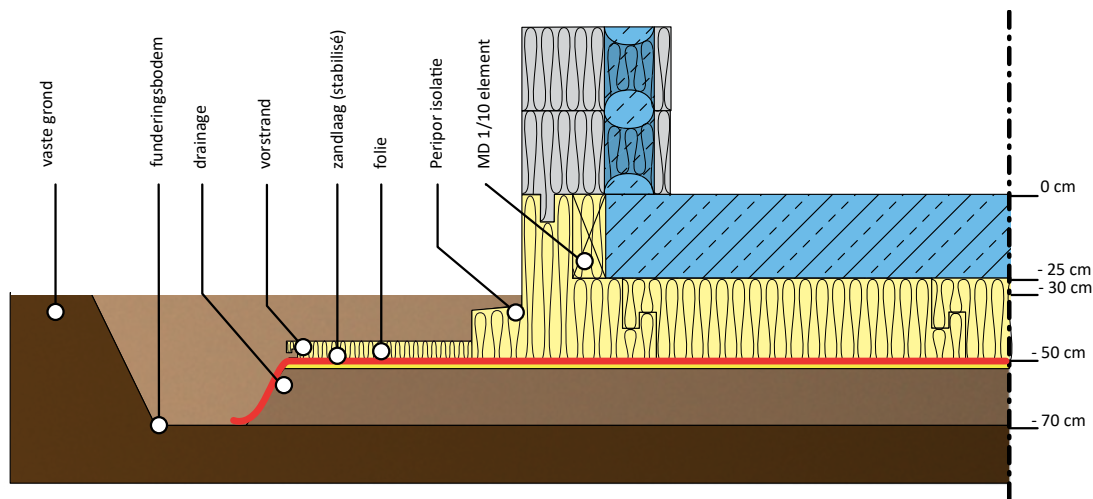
Uitvoeringsschema voor een funderingsplaat met buitenmuren van 45 cm (Super King Blok)
